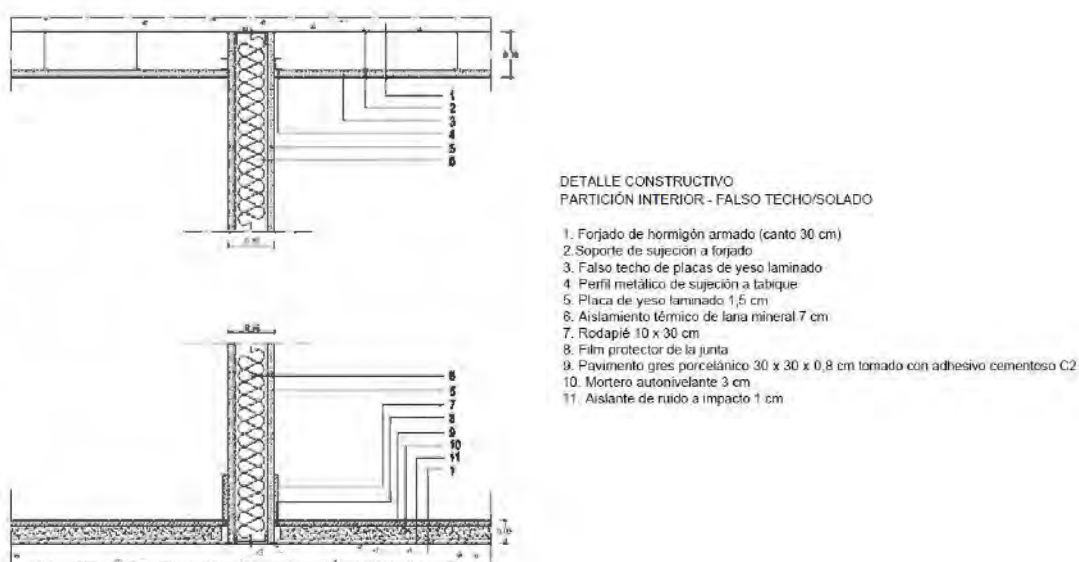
Detalle constructivo particiones interiores. Fuente: propia.
